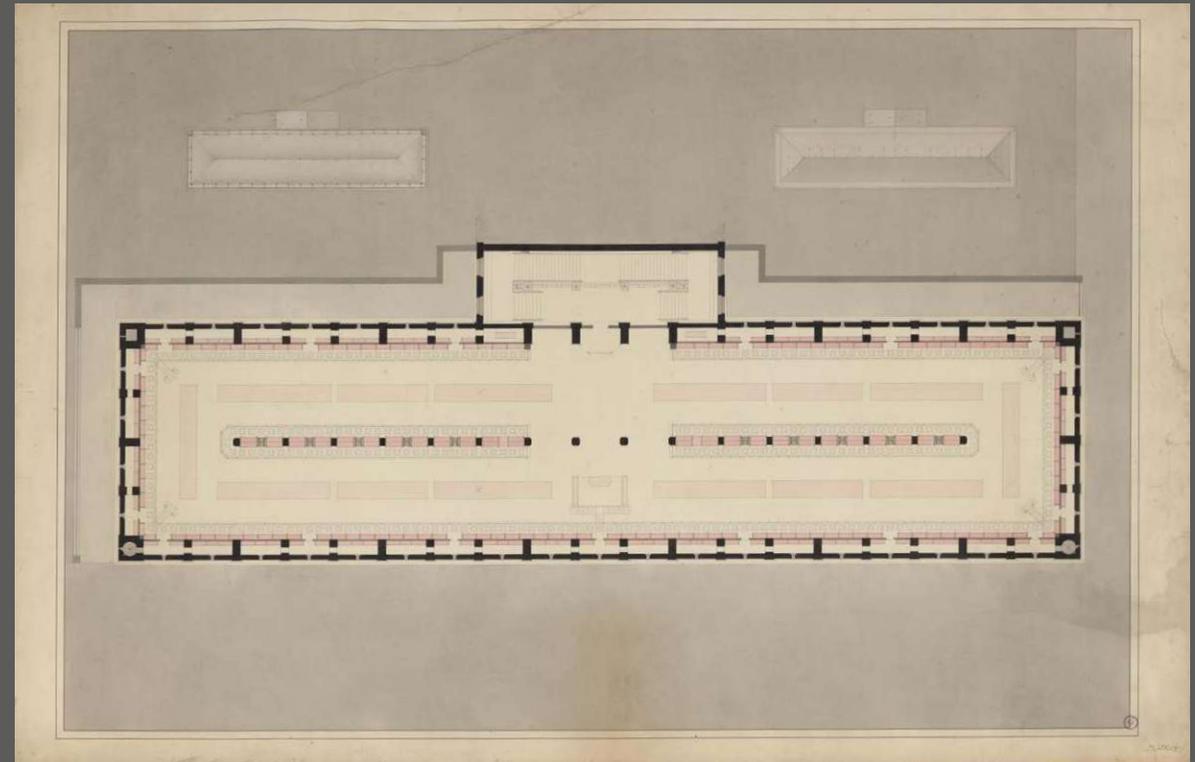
Bibliothèque Saint-Geneviève, Grundriss, Paris
